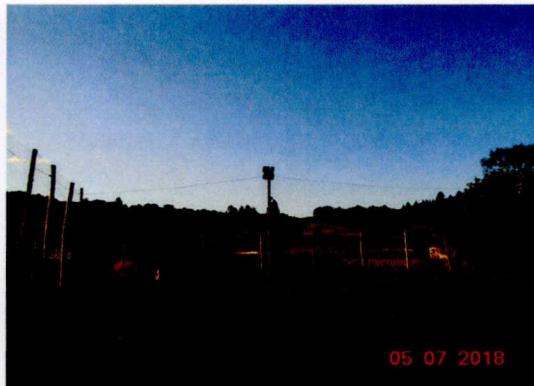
imagem do campo de futebol existente, local onde está prevista a execução da nova Quadra Coberta;
